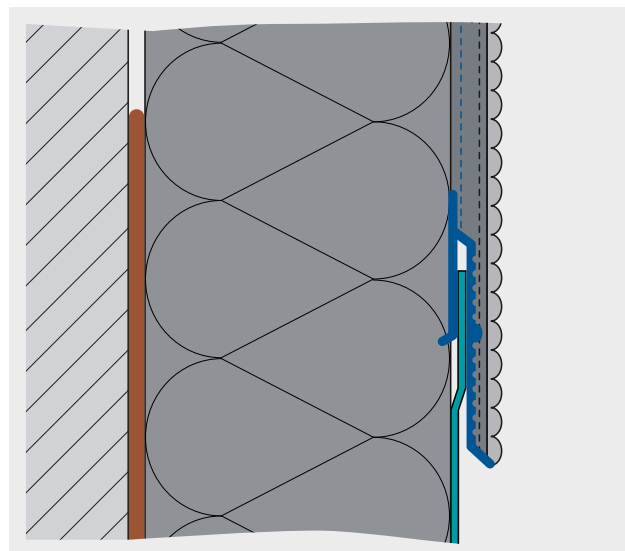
Beispielhafte Ausführung mit Aufsteckprofil
